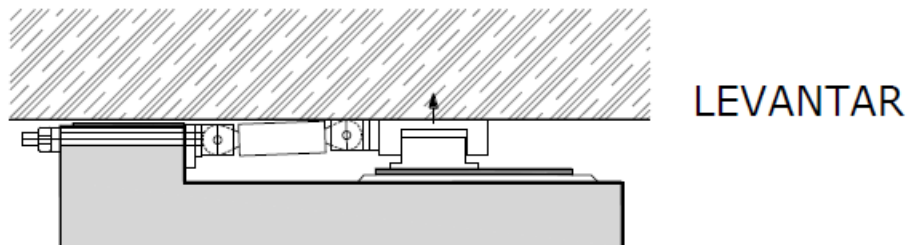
Levantamento do tabuleiro(Martins, 2009).
